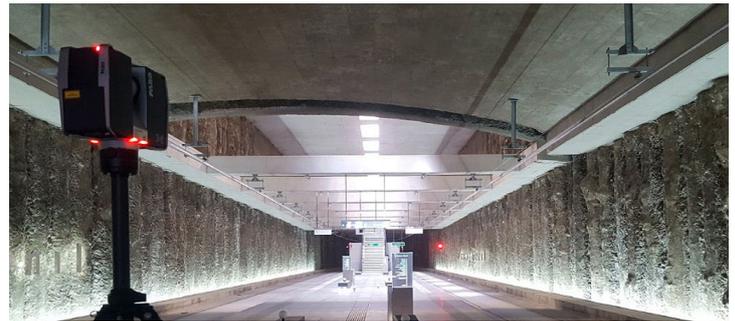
Levantamiento con escáner láser. Fuente: Equipo BIMnD, "8 ventajas de la medición con Escáner Láser 3D," accessed September 26, 2021, <https://www.bimnd.es/fotogrametriaversusescaner3d/>.
